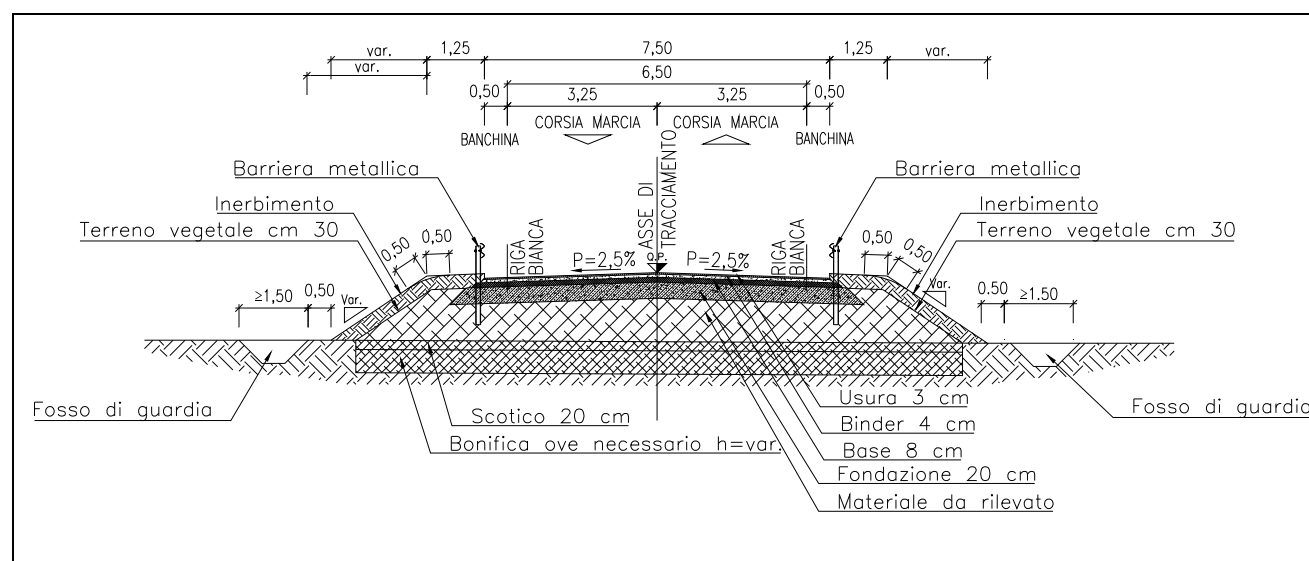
TRATTA AMMODERNAMENTO VIABILITA' ESISTENTE SEZIONE TIPO "F LOCALE" IN RILEVATO
